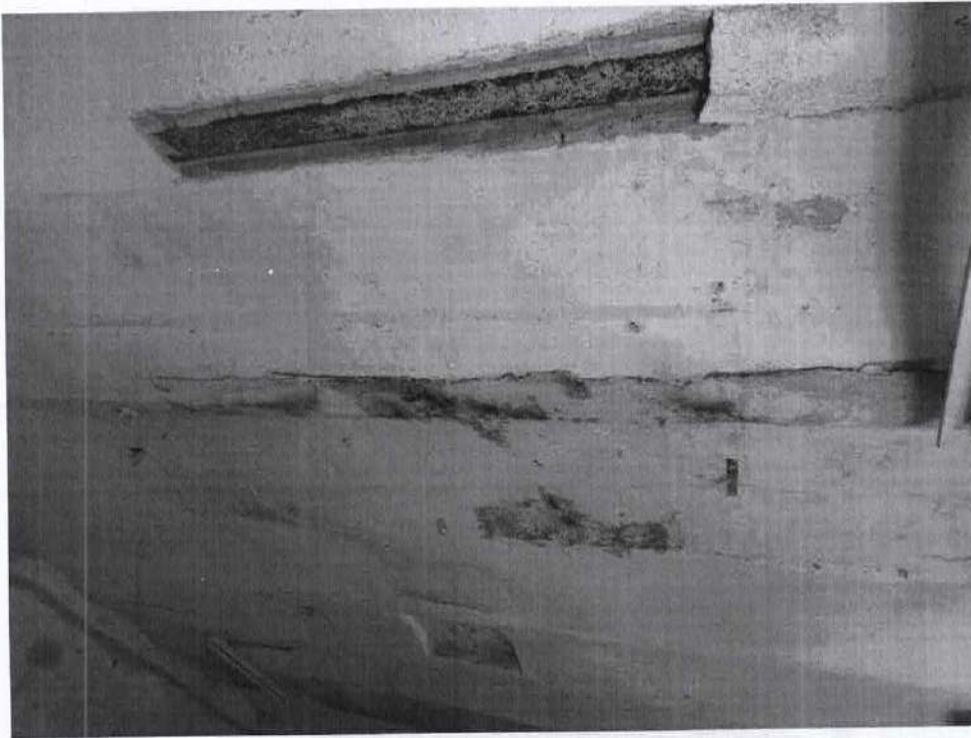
solaio di copertura del piano terreno, macchie di umidità, muffe, distacco intonaci e ossidazione travi
